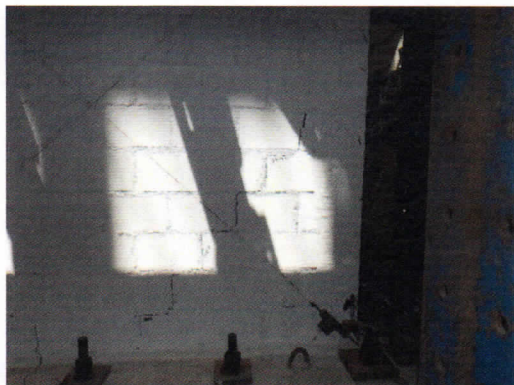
Formación de grietas diagonales en el mortero hasta antes de la parte central en la parte inferior Oeste de la cara Norte para una distorsión 1/1500.
